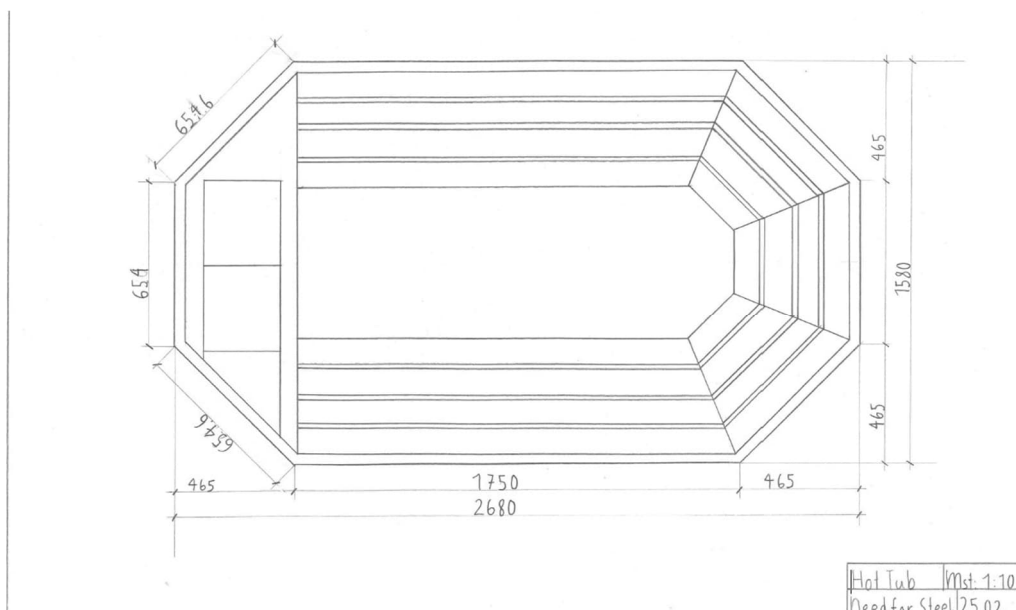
Grundriss Hot-Tub achteckig mit Ofen
